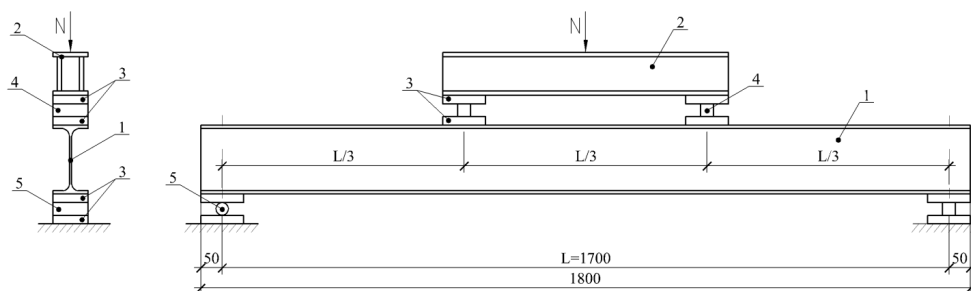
Схема испытания двутавровых балок на изгиб. 1-двутавровая балка I-16Б2; 2- траверса; 3-распределительная пластина; 4- шарнирно-неподвижная опора; 5-шарнирно-подвижная опора
